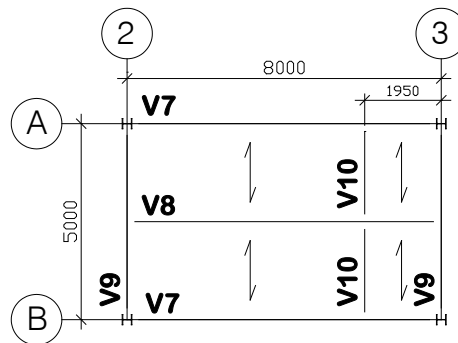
Sistema estrutural do piso da caixa d'água e nomenclatura das vigas [3].
